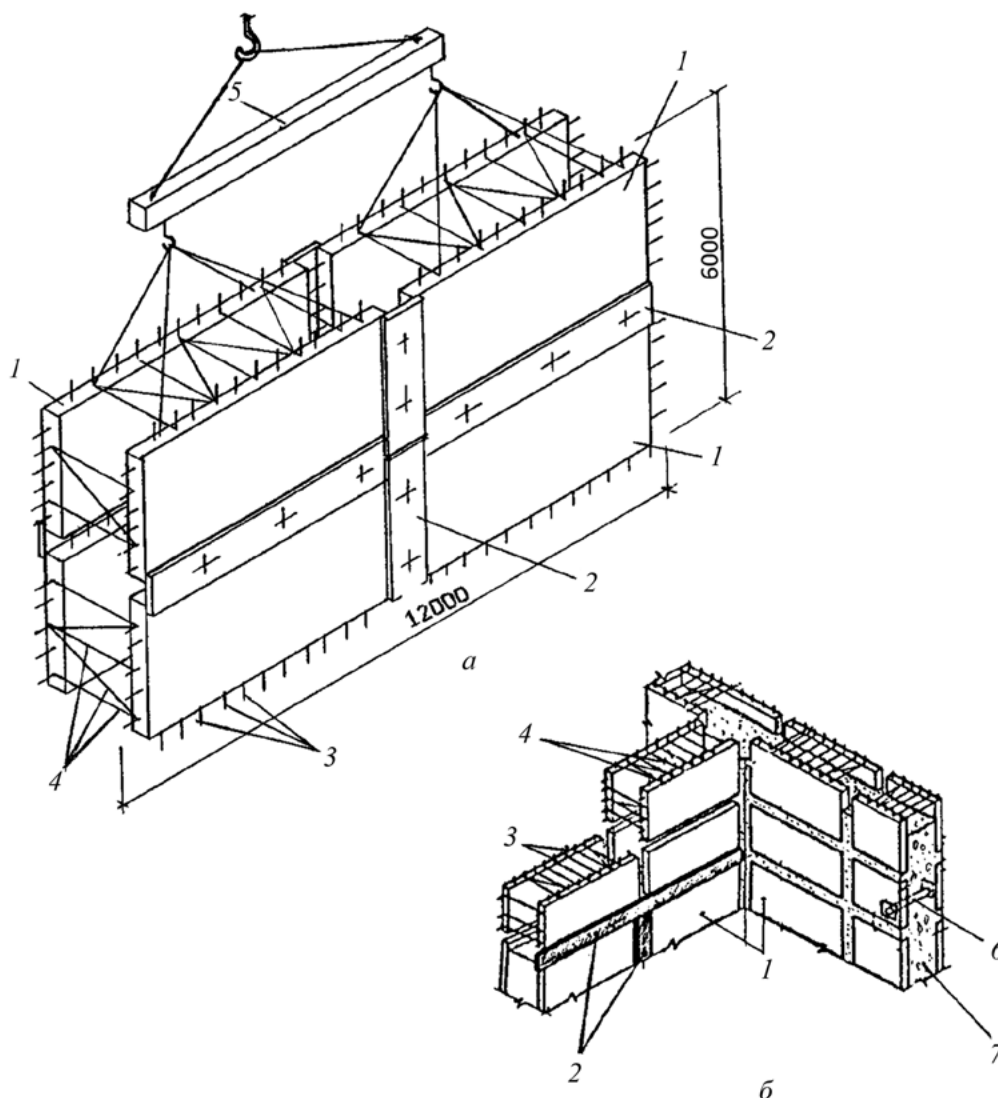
Укрупненный стеновой блок несъемной опалубки: а — на монтаже; б — фрагменты стены с опалубкой; 1 — железобетонная плита несъемной опалубки; 2 — съемная опалубка (нащельник); 3 — выпуски арматуры из плиты; 4 — элементы, связывающие две плиты в стеновой блок (уголки, арматура); 5 — траверса; 6 — проходка; 7 — монолитный бетон
